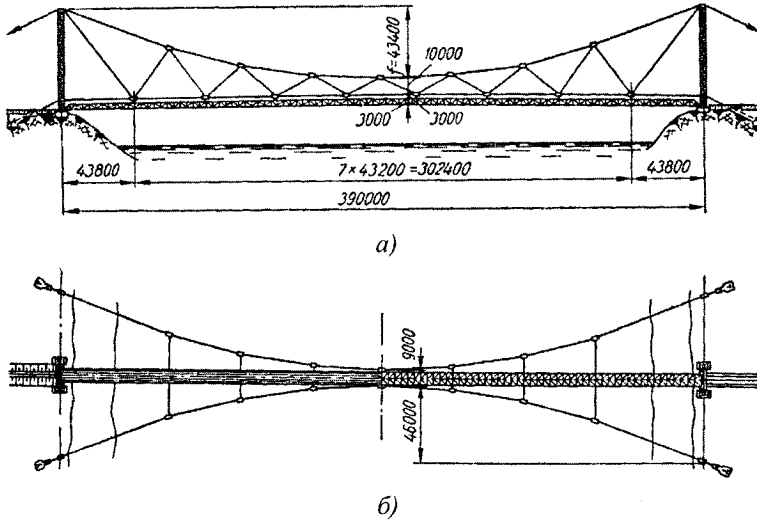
Перехід газопроводу через р. Амудар'ю на магістралі Бухара – Урал з вантовими фермами: а – фасад; б – план
